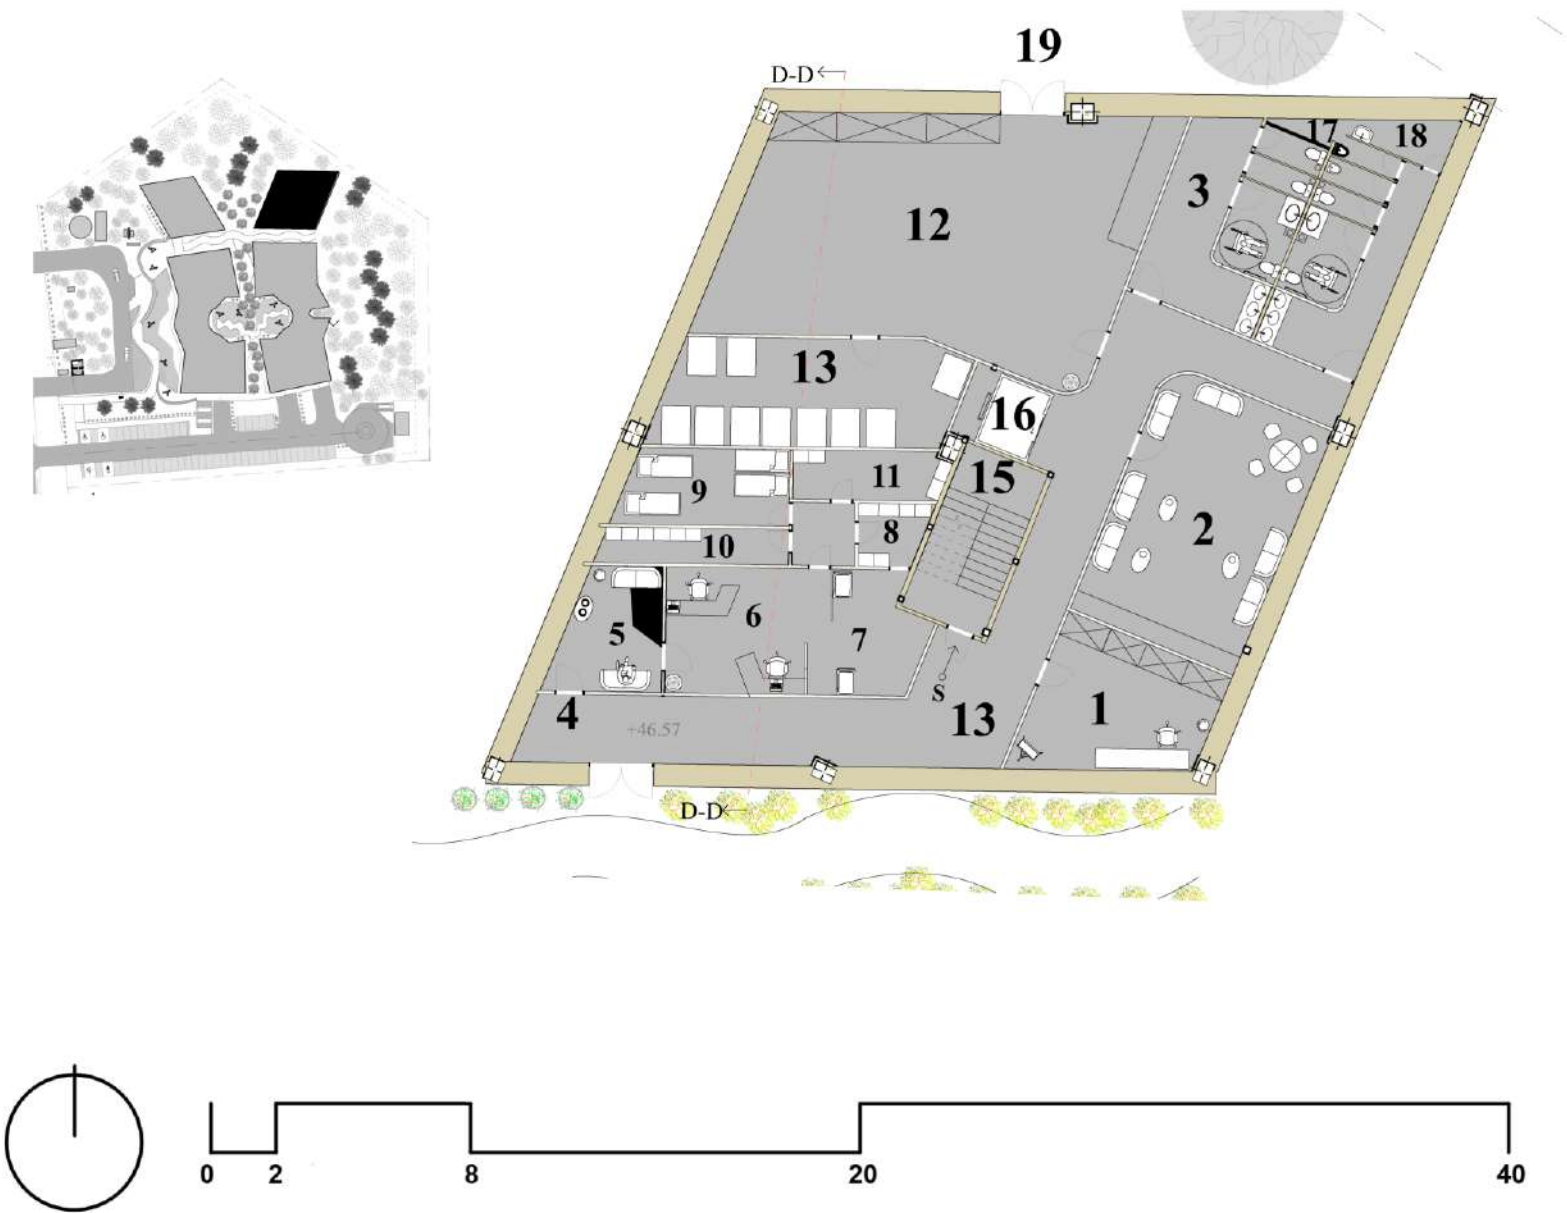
Planta Arquitectónica de nivel 00, edificio D, elaborado por autor, 2024.
